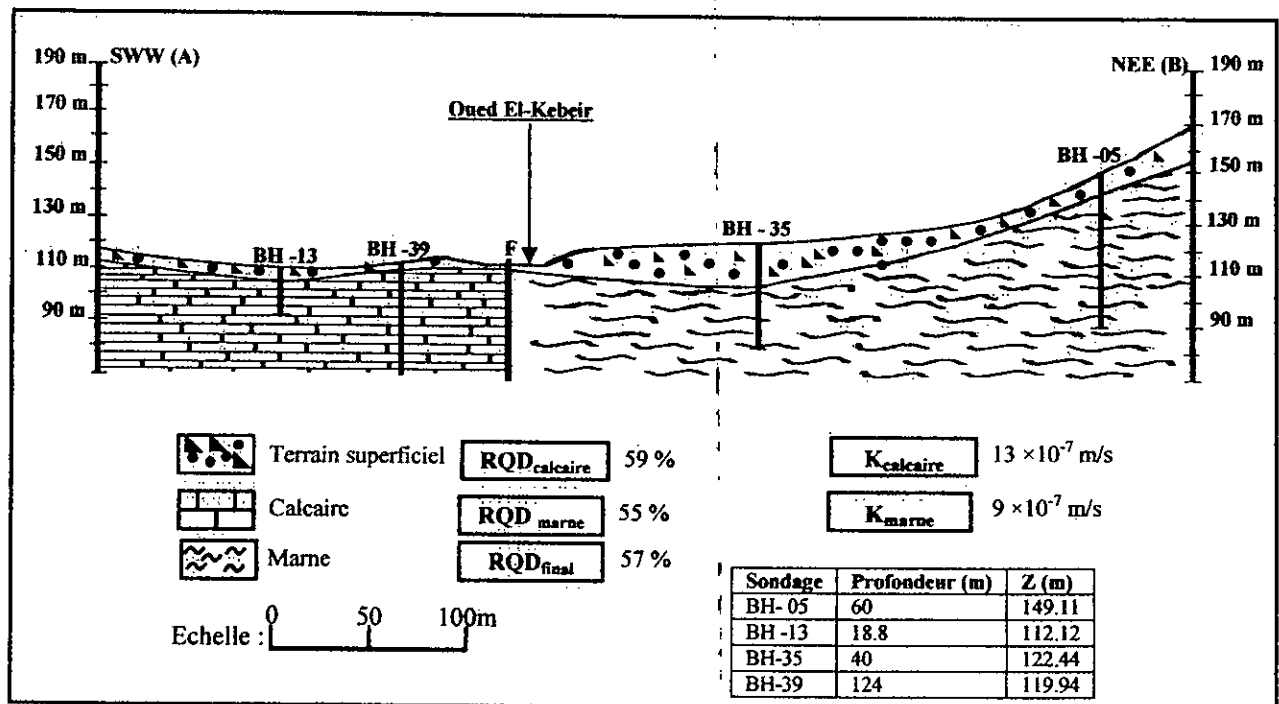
Coupe géotechnique coupe l'axe du barrage
